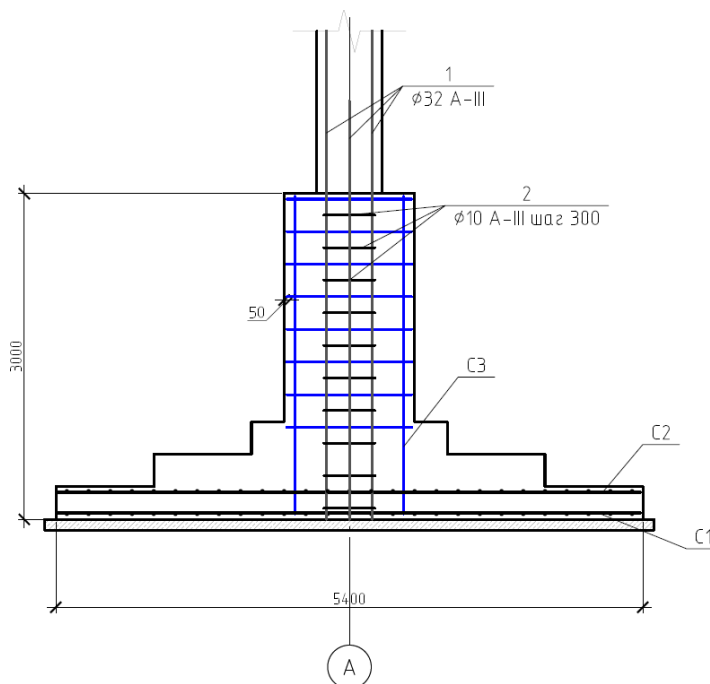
Схема армирования столбчатого фундамента под монолитную железобетонную колонну
